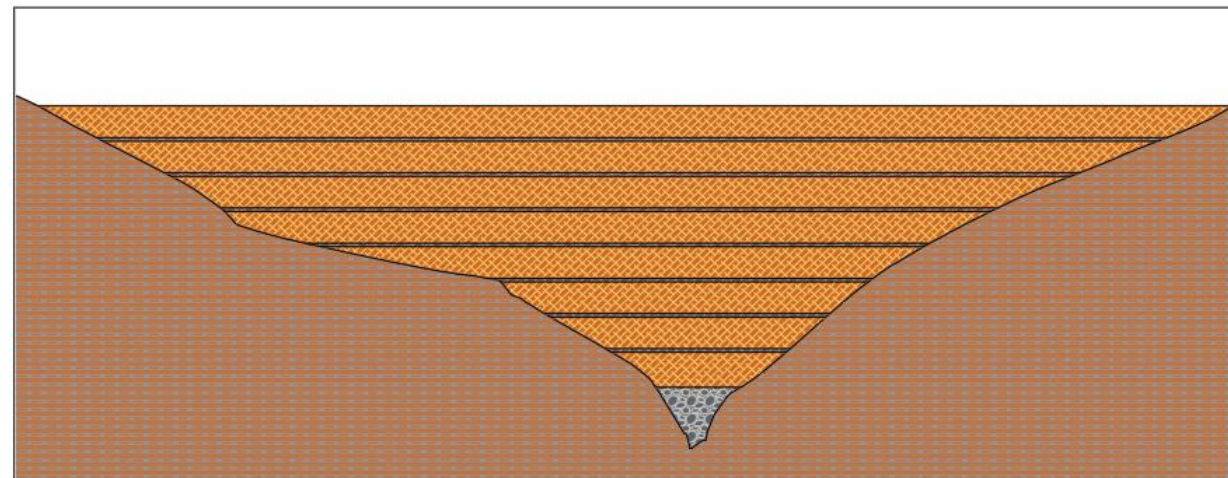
Drenaje multicapa sobre el perfil B.
